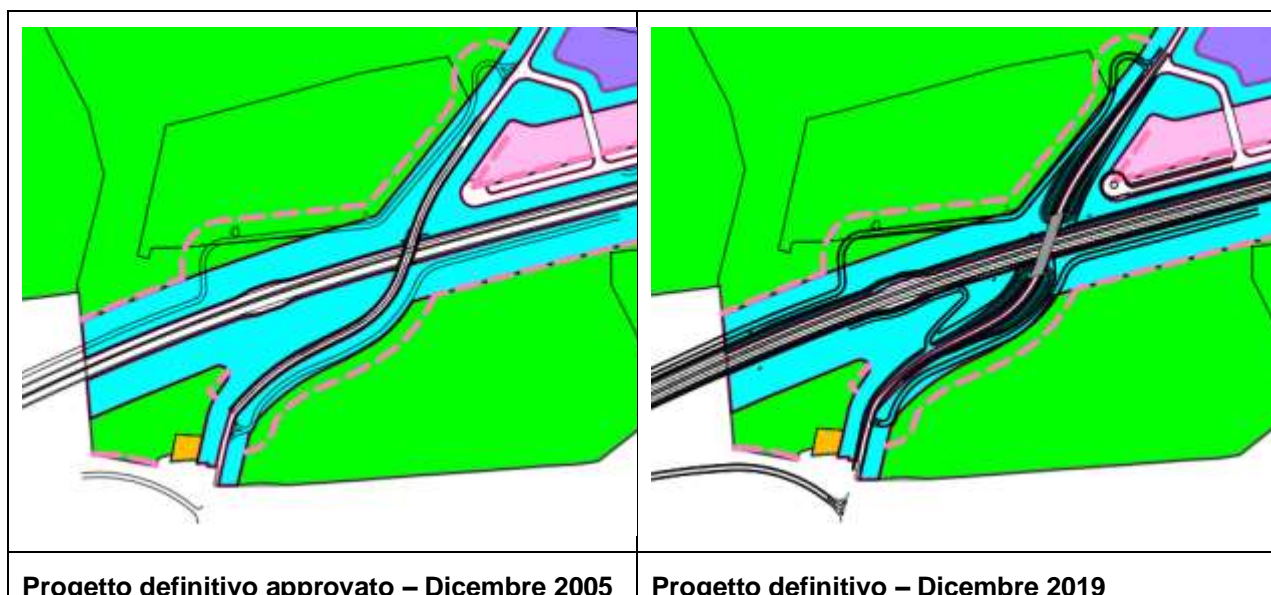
Scavalco 3 CV10 con indicazione dell'adeguamento della fascia di rispetto 2005 sulla base del progetto approvato.
